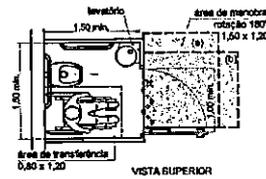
Boxe para bacia sanitária — Reformas — Área de manobra externa — Exemplo
